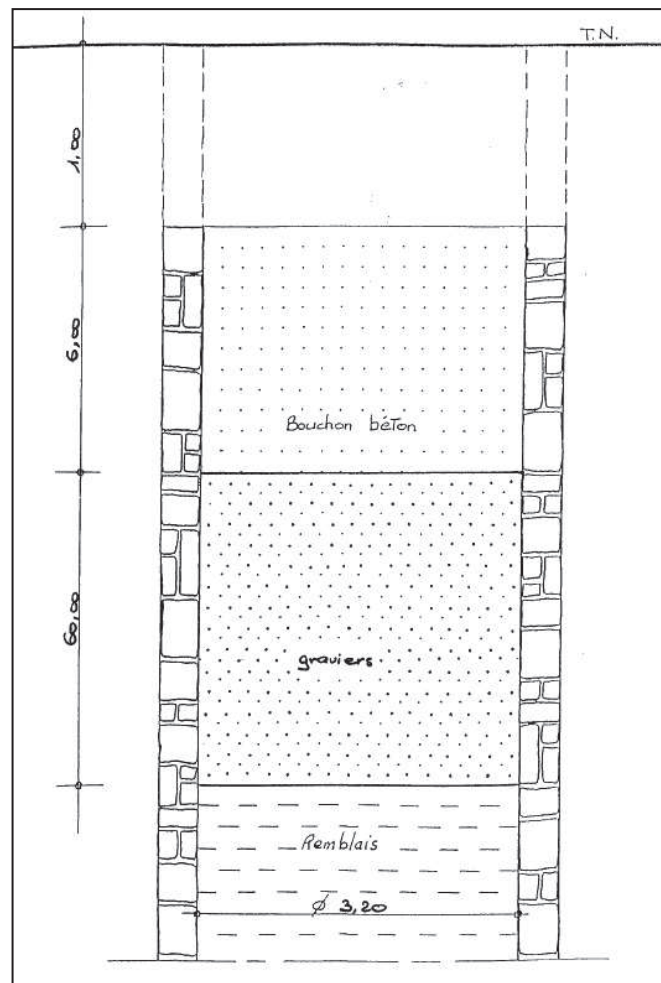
Schéma de mise en place du bouchon béton du puits Denières
